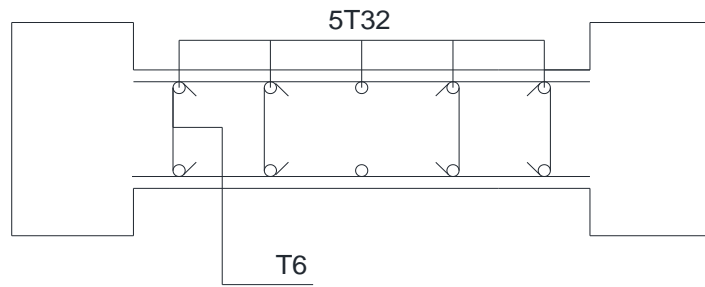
Schéma de ferrailage du voile (poutres noyées - plan fortement irrégulier)
